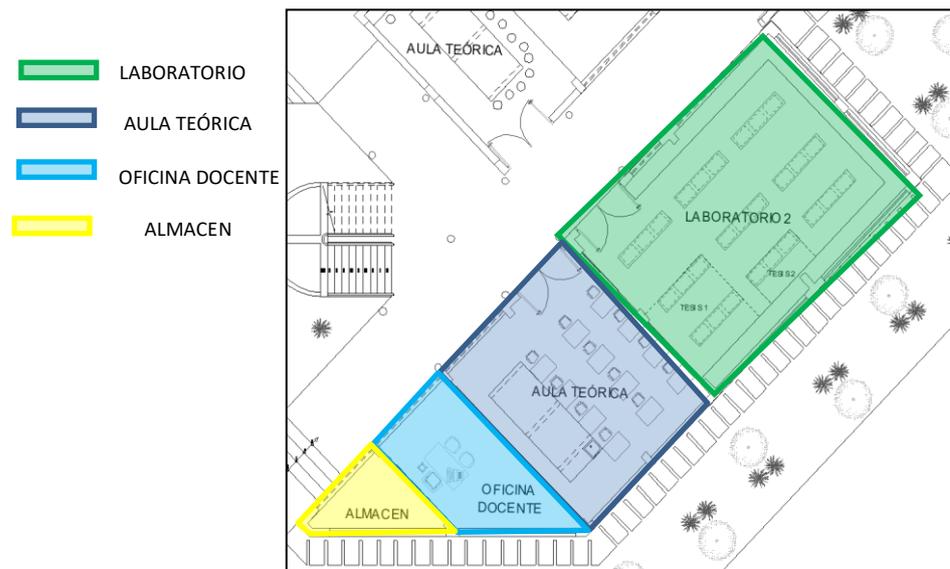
Plano actual de arquitectura del laboratorio 3
